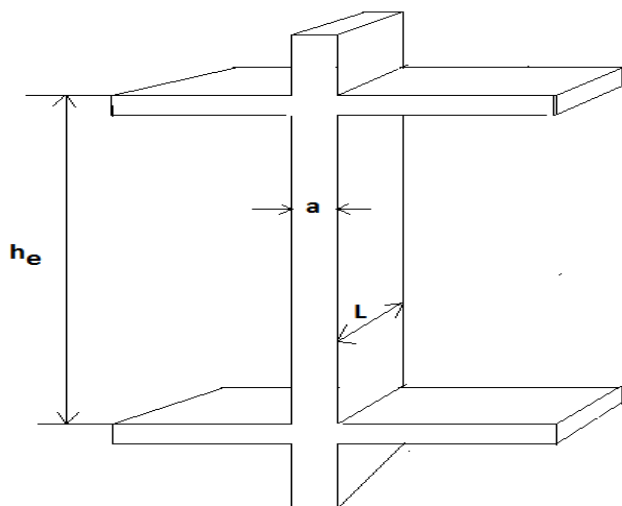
Schéma d'un voile plein et disposition du ferrailage.
